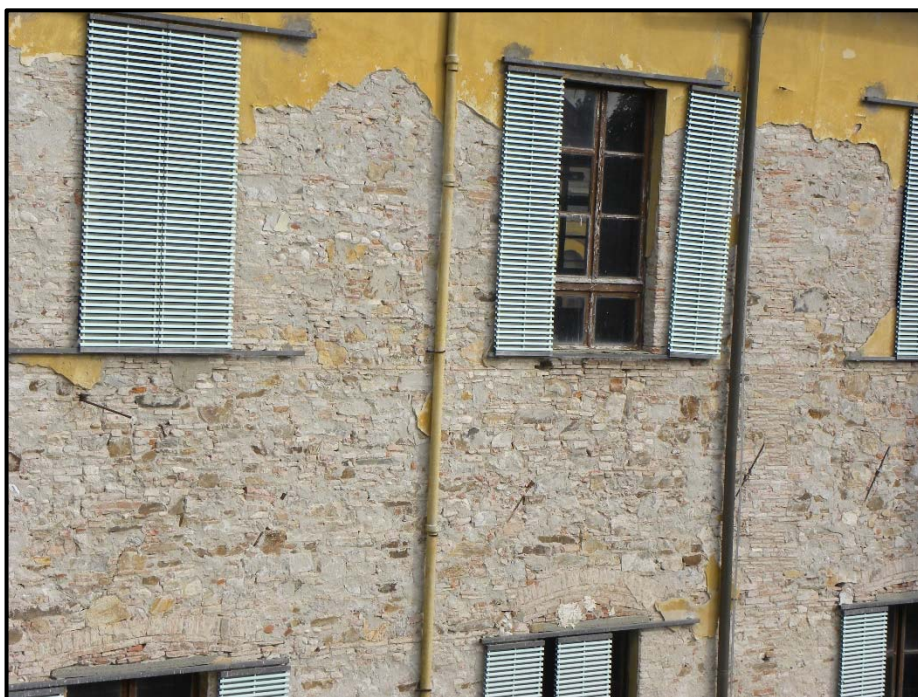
Prospetto Sud- Particolare della tipologia di muratura
